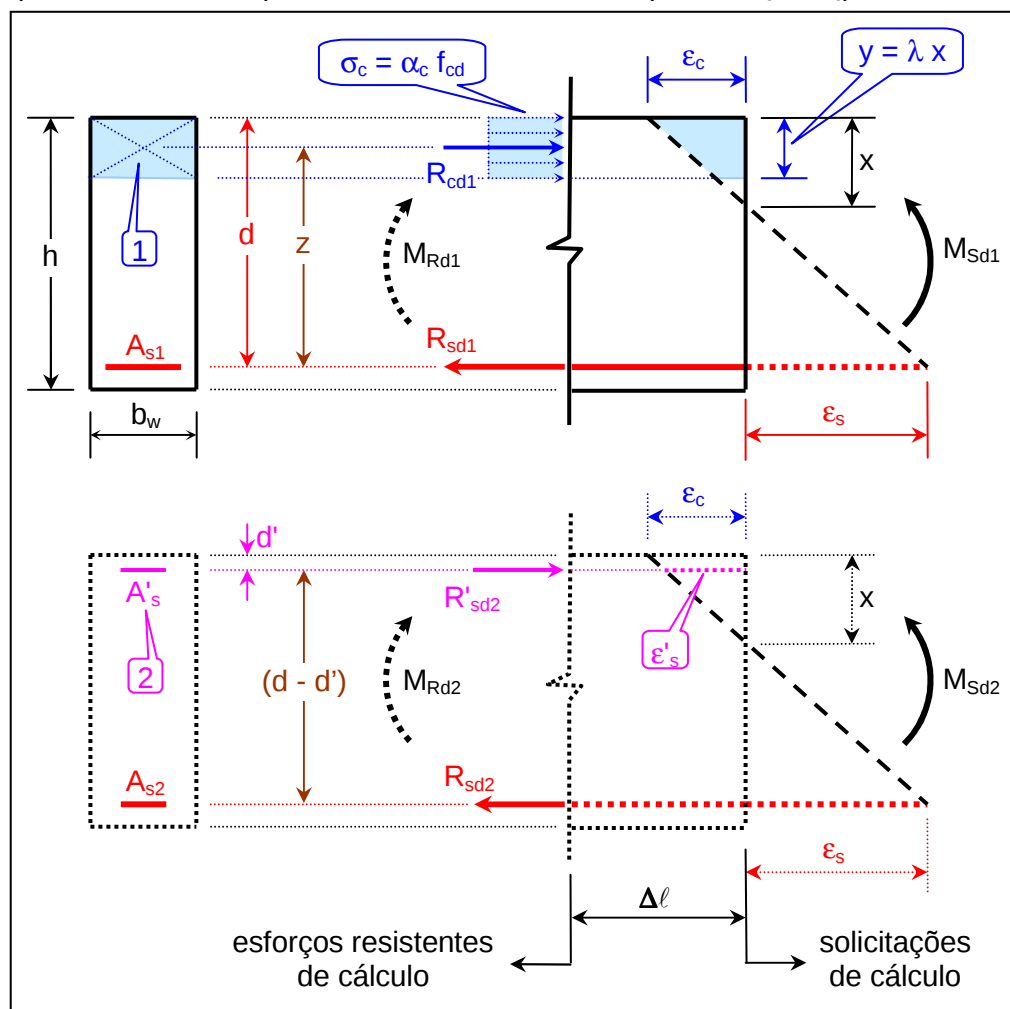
Vigas de seção retangular com armadura de compressão
